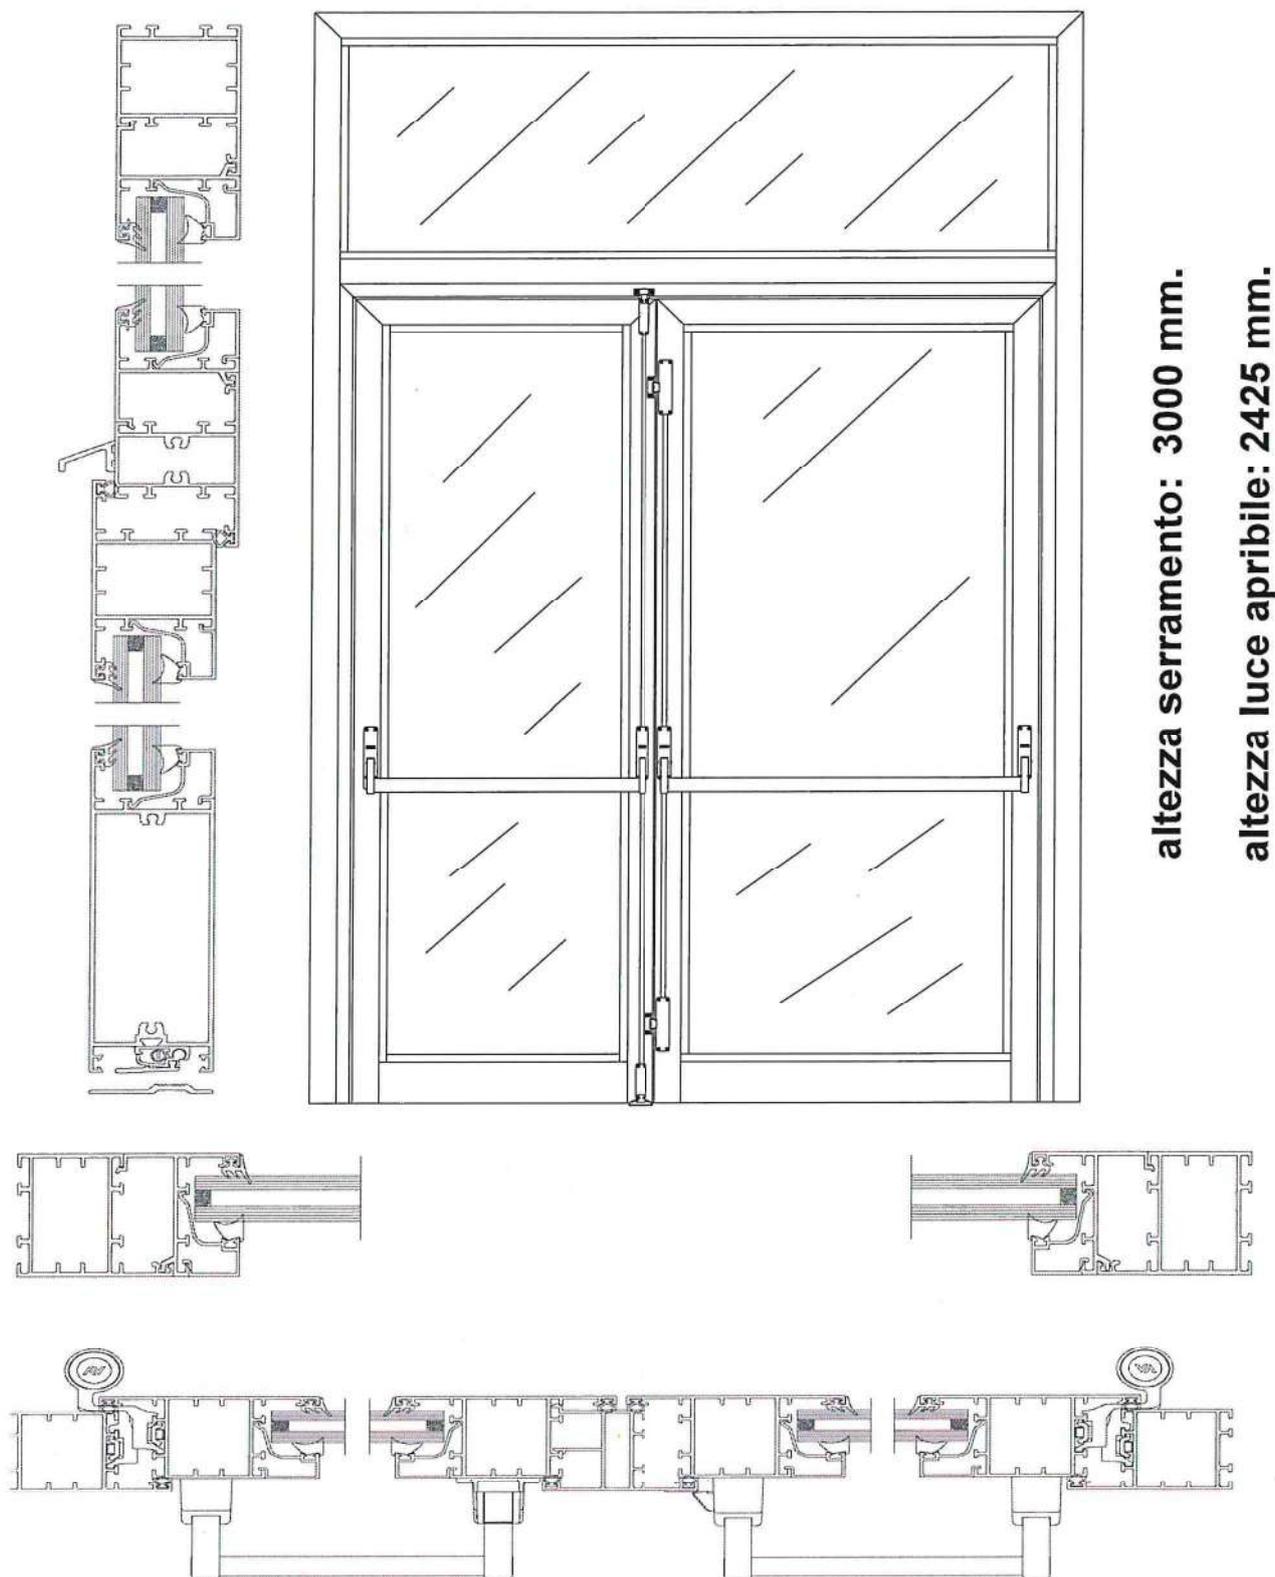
Prospetto e sezioni orizzontale e verticale del campione sottoposto a prova
